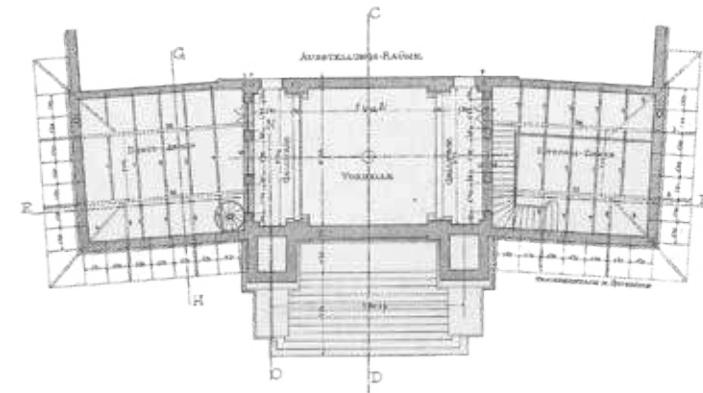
Grundriss Obergeschoss Maßstab ca. 1:350
